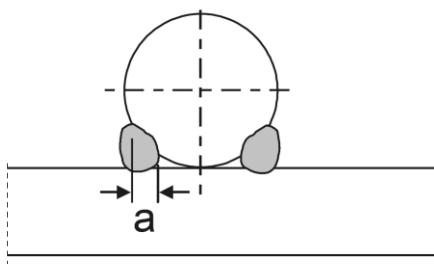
Эффективная высота сварного шва с конусным зазором
